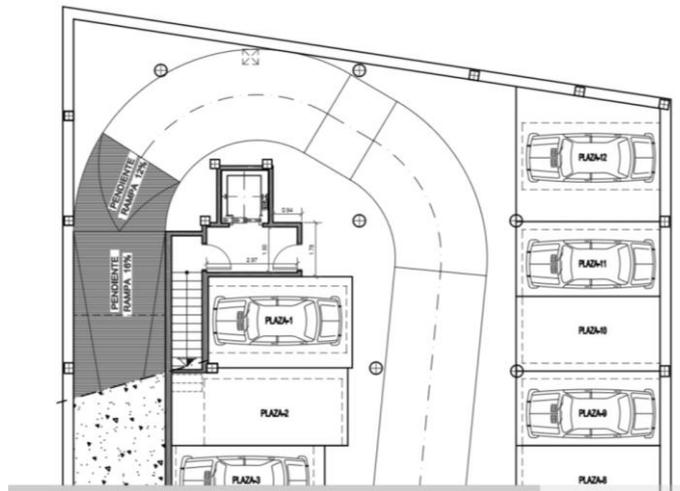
Plano de Planta Sótano de proyecto, 2010.
